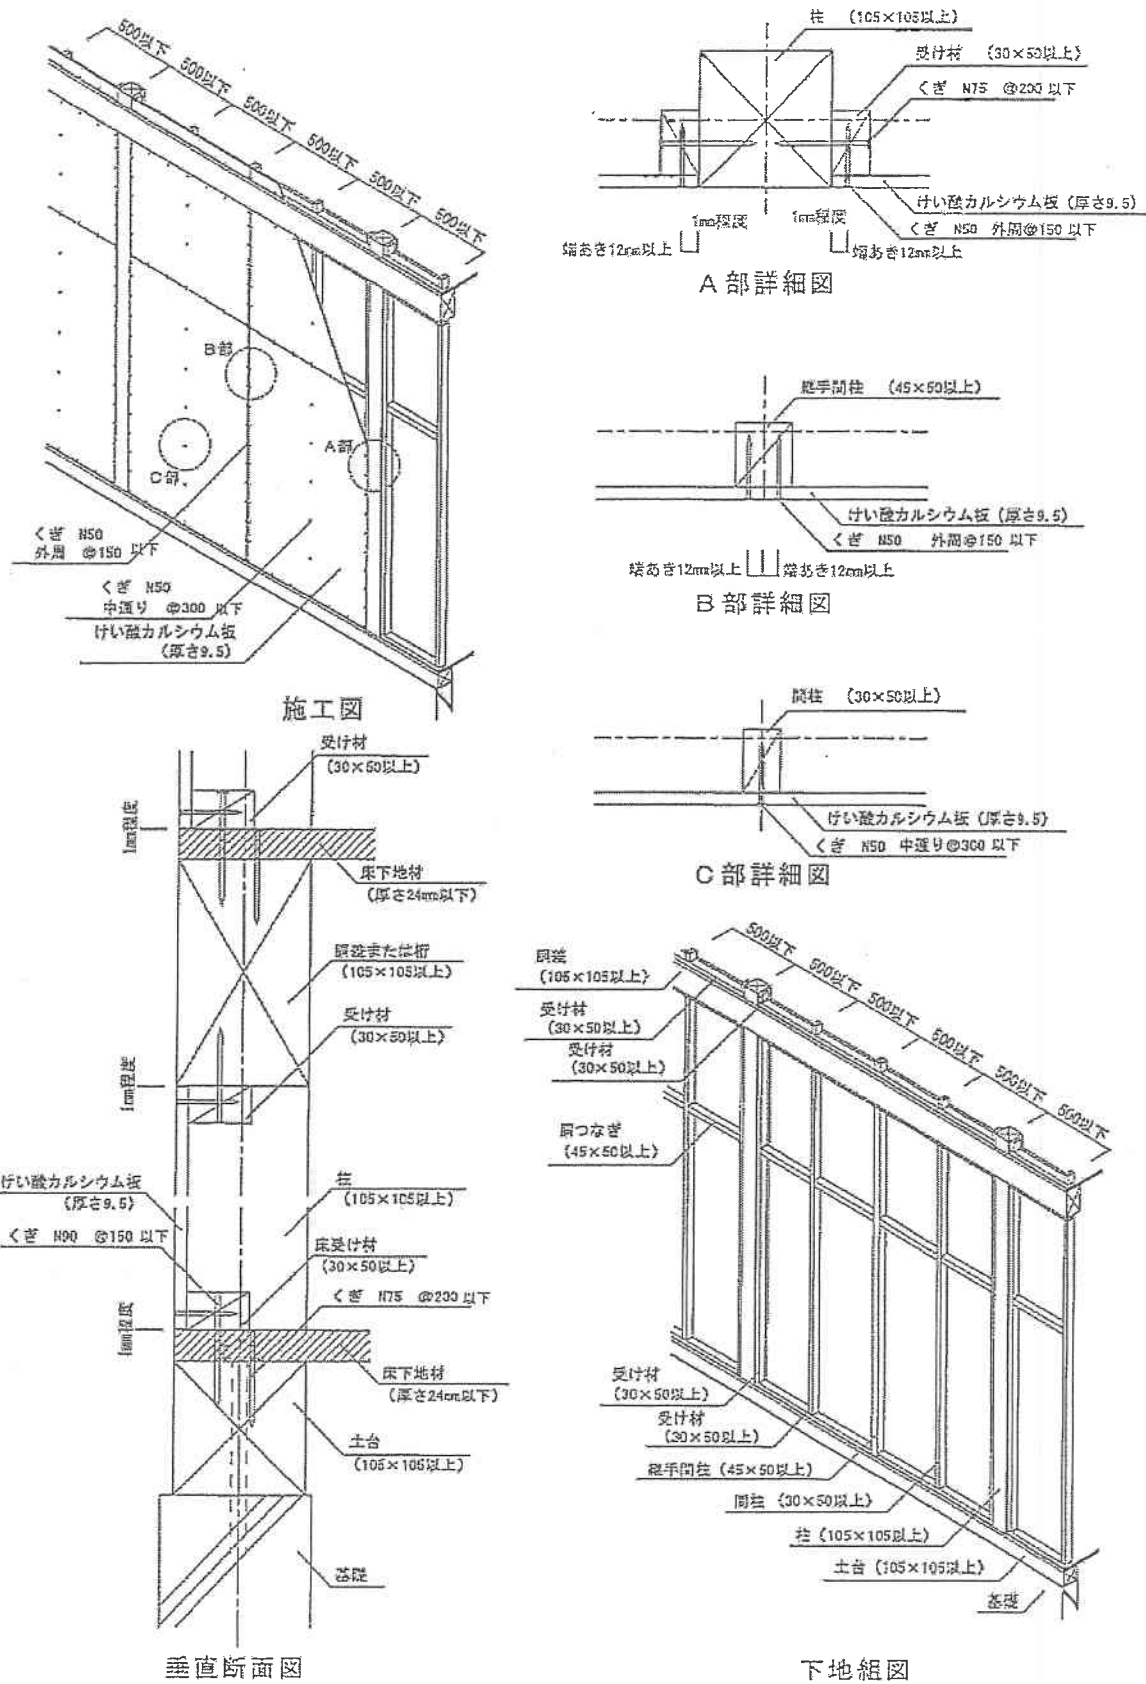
施工図：面材と柱が面一となる場合 (寸法単位：mm)
